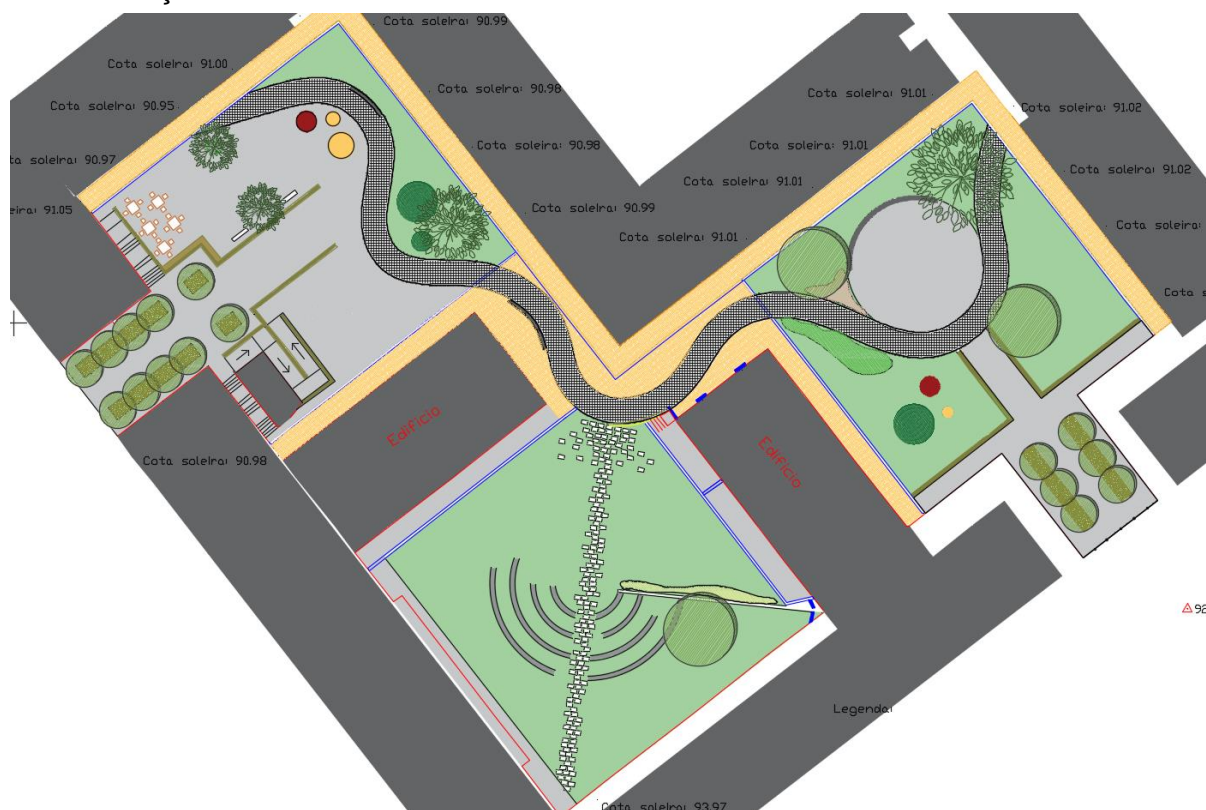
Proposta: Planta Geral Logradouros Bairro Fonseca e Calçadas.
